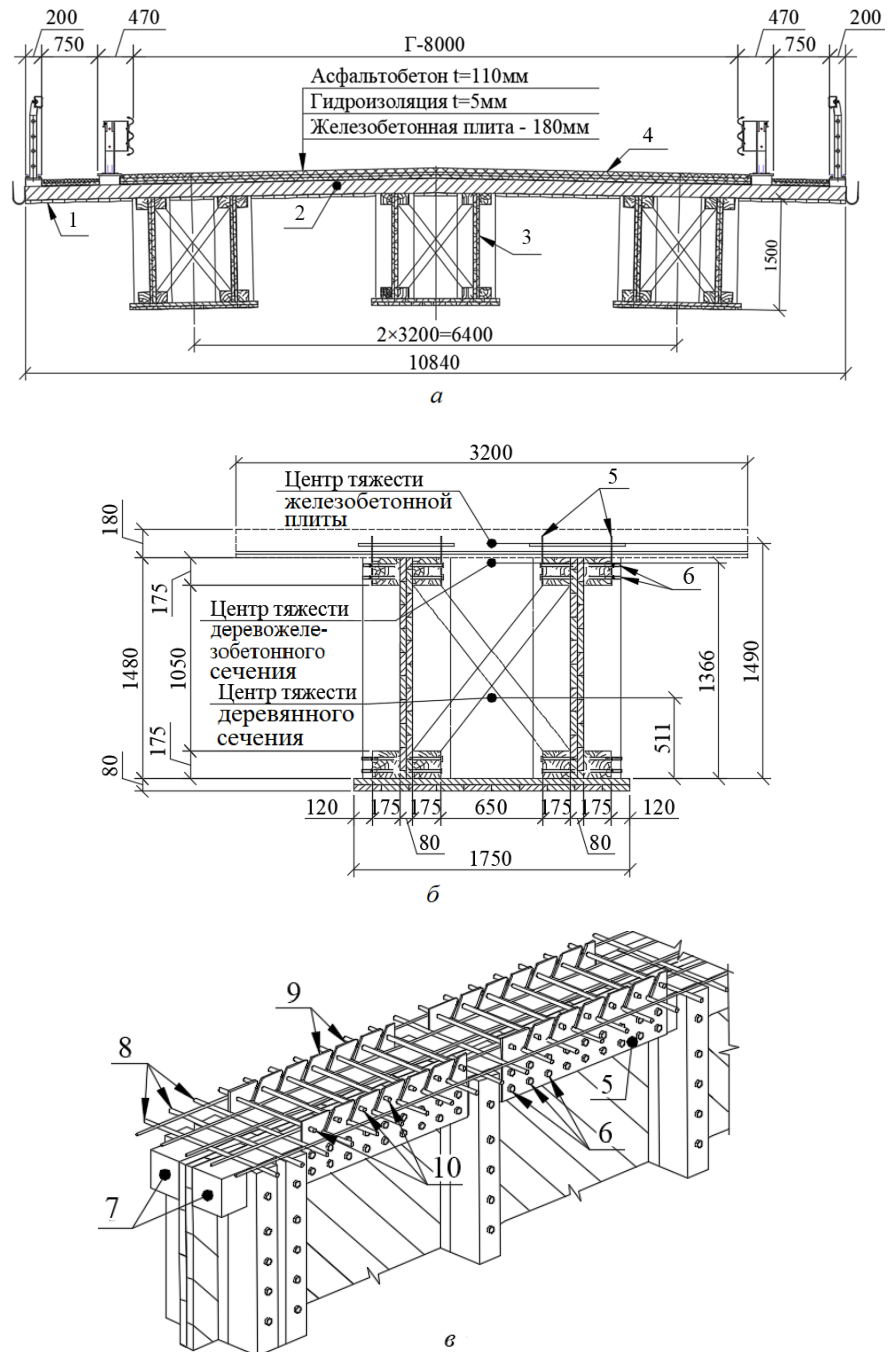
Поперечное сечение дощато-гвоздевого пролетного строения с монолитной железобетонной плитой проезжей части: *a* – общий вид; *b* – конструкция отдельного блока; *в* – конструкция объединения дощато-гвоздевых блоков с железобетонной плитой
